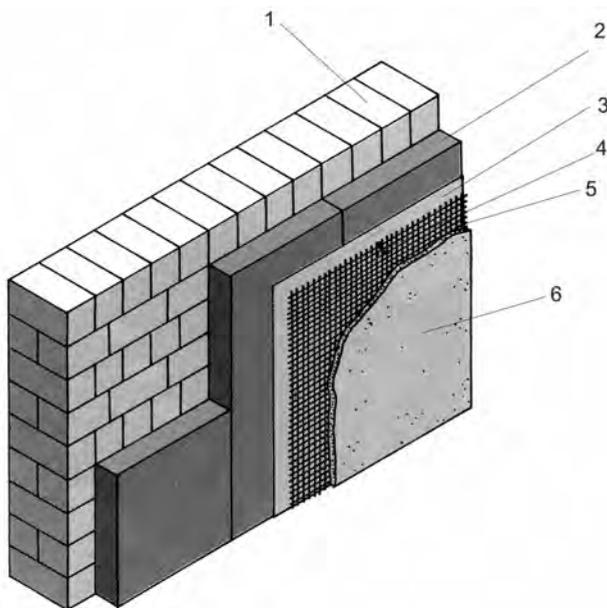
Комплексная система термоизоляции (термооболочка): 1 — наружная стена; 2 — теплоизолирующие плиты (один или два слоя); 3 — слой штукатурки; 4 — штифт или дюбель; 5 — армирующая стеклоткань; 6 — наружная штукатурка в два слоя
